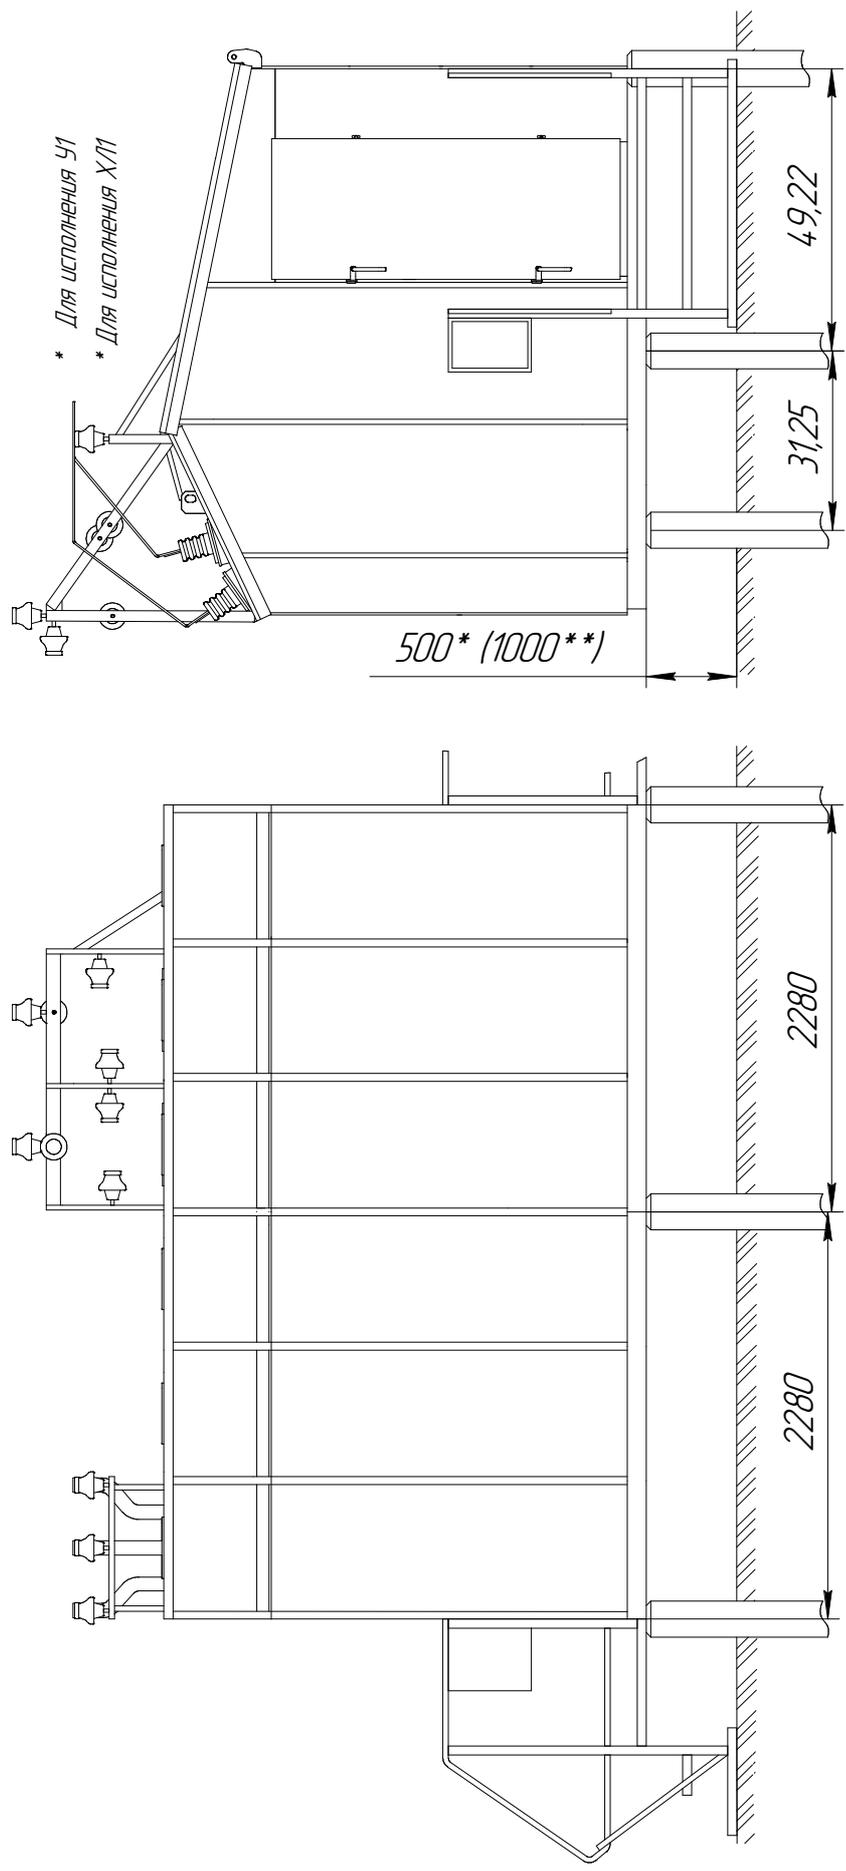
Вариант установки КРУН (на заглубленном фундаменте)
